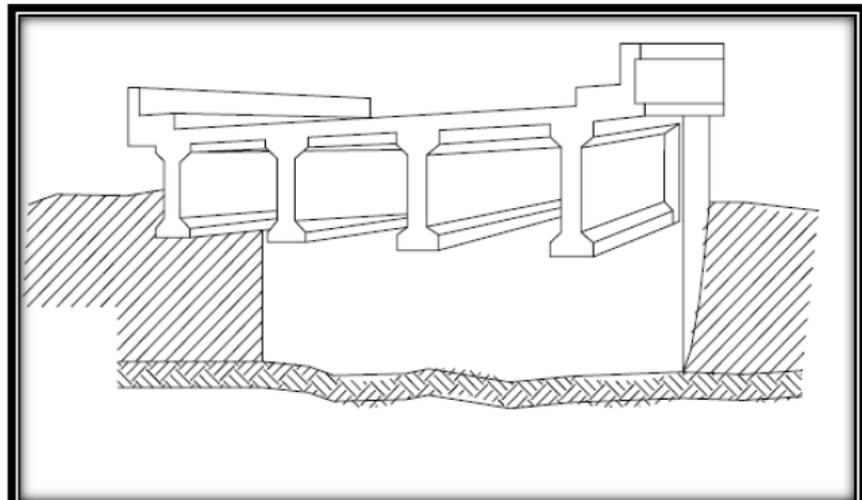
Puentes de losa con vigas en concreto pretensado
